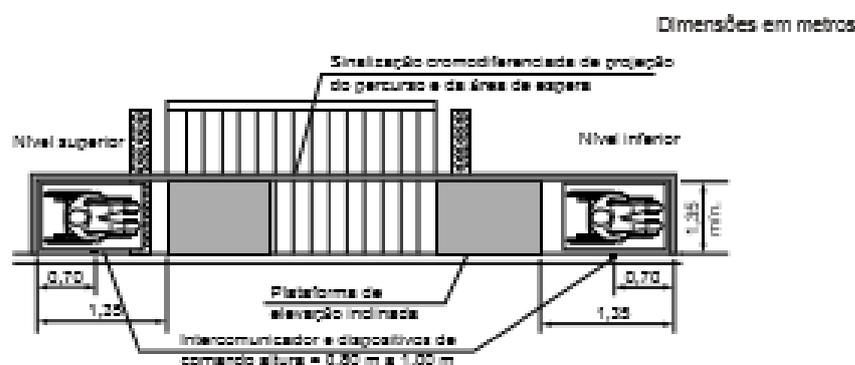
Sinalização de piso junto à plataforma de elevação inclinada – Vista superior
